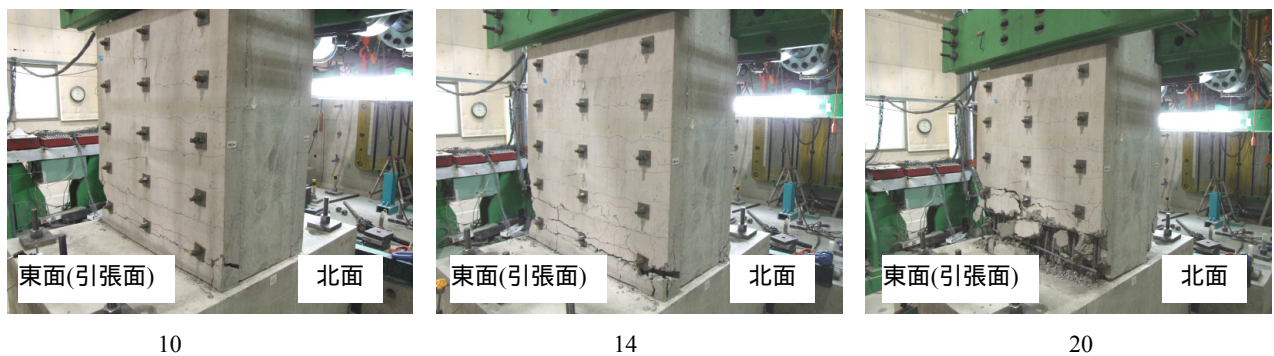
引張面のひび割れ発生状況 (RC-S-16)
